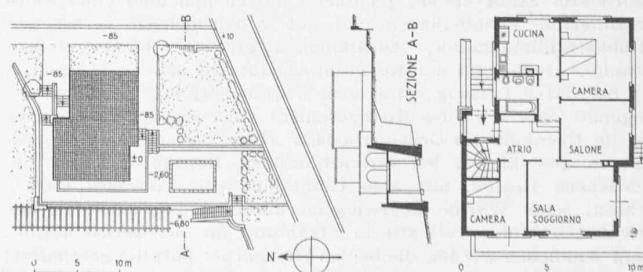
Lageplan 1 : 800, Schnitt und Grundriss 1 : 400
